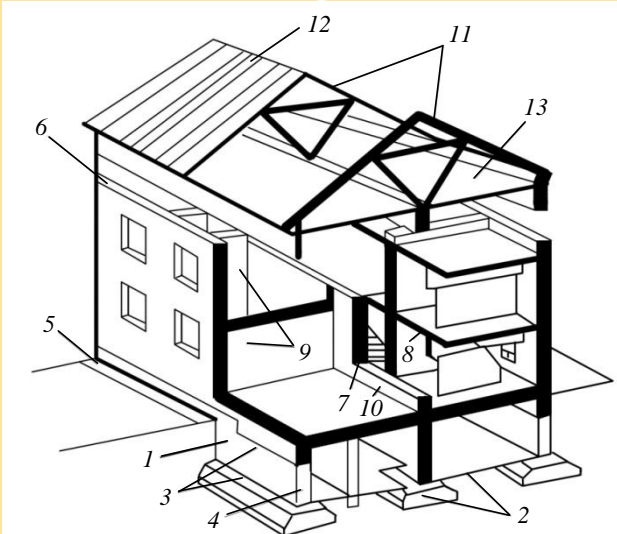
Схема конструкції будинку: 1 – фундамент; 2 – підлога підвалу; 3 – гідроізоляція; 4 – стіни підвалу; 5 – вимощення; 6 – зовнішні стіни; 7 – внутрішні стіни; 8 – міжповерхові перекриття; 9 – перегородки; 10 – сходи; 11 – крокви; 12 – покрівля; 13 – горіщне перекриття [8]
